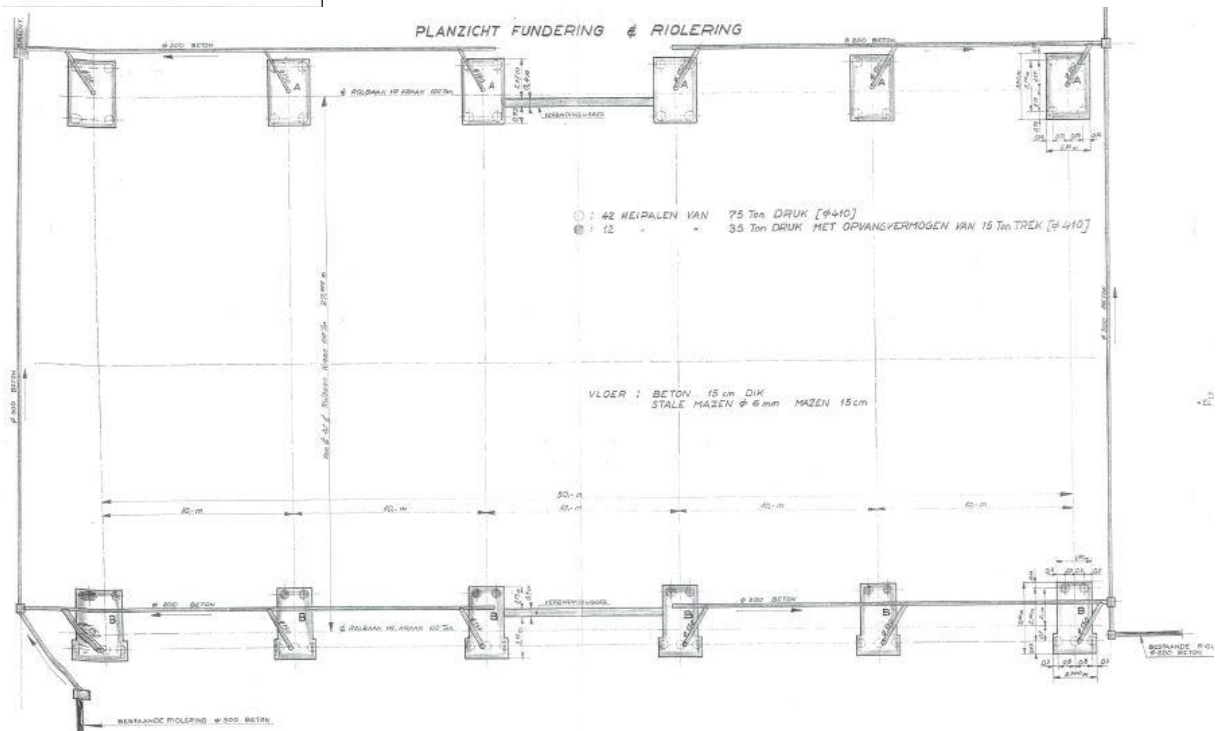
Detail belangrijkste te slopen bebouwing (Bron: Mertens-Architecten)
